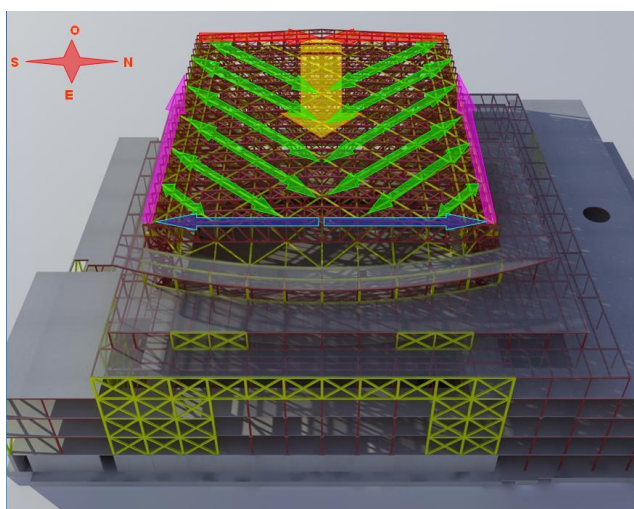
Vista de la estructura del Auditorio durante su construcción.
